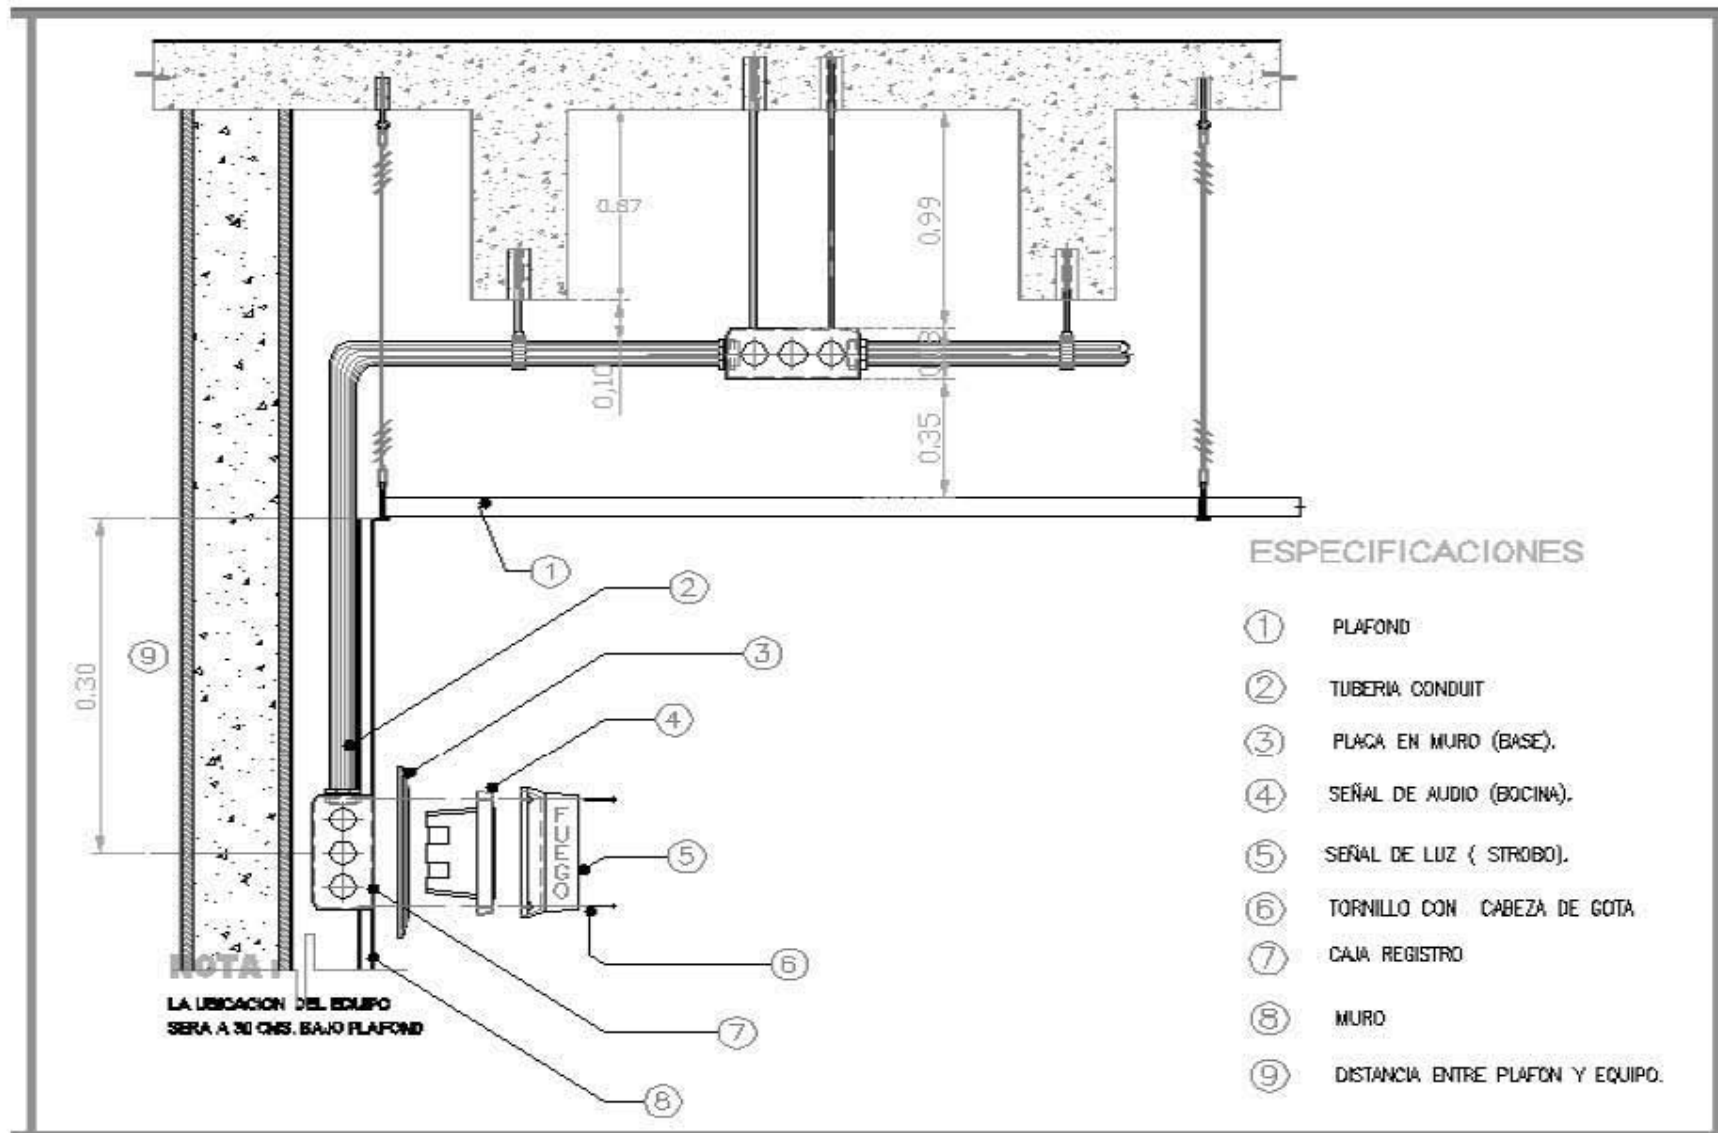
Detalle de instalación para bocina con luz estroboscópica en muro.
